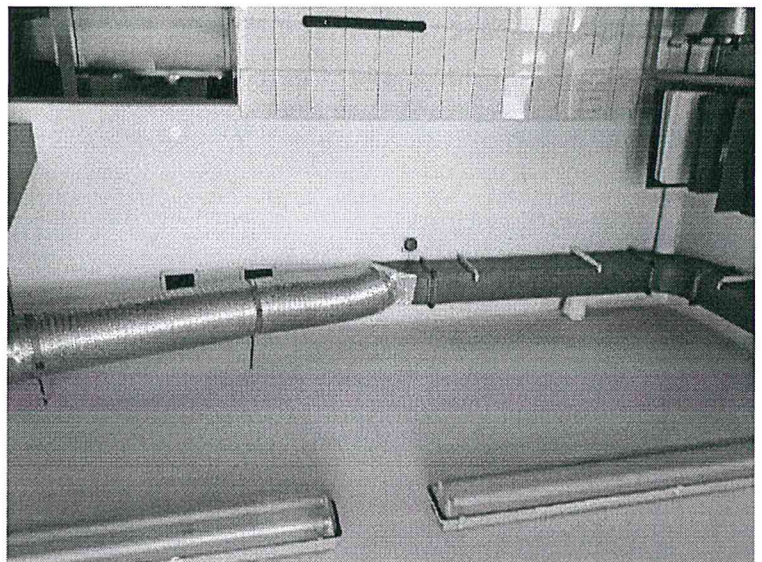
Kanał wyciągowy – widok w kierunku pionu.
